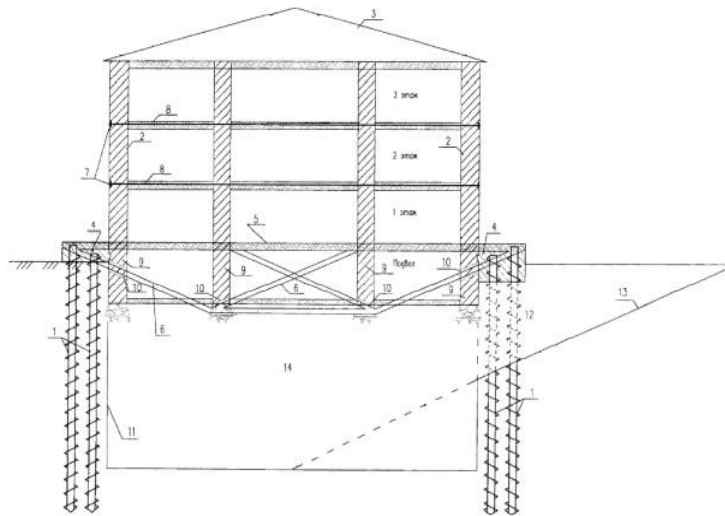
Схема влаштування підземного поверху 1 – одинарний чи подвійний ряд паль; 2, 3 – будинок; 4 – складний ростверк; 5 – з/б плита; 6 – стрижні ферм; 7 – пояси посилення; 8 – перекриття; 9 – стіна підвалу чи цокольного поверху; 10 – отвори для стрижнів ферм; 11 – об'єм підземного об'єкта; 12 – порталний отвір; 13 – пандус; 14 – ґрунт
